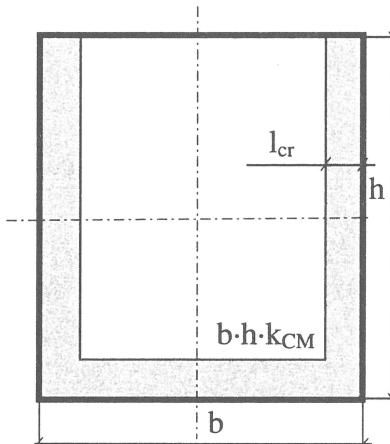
Область сечения бетонной конструкции, сохранившая свои свойства
